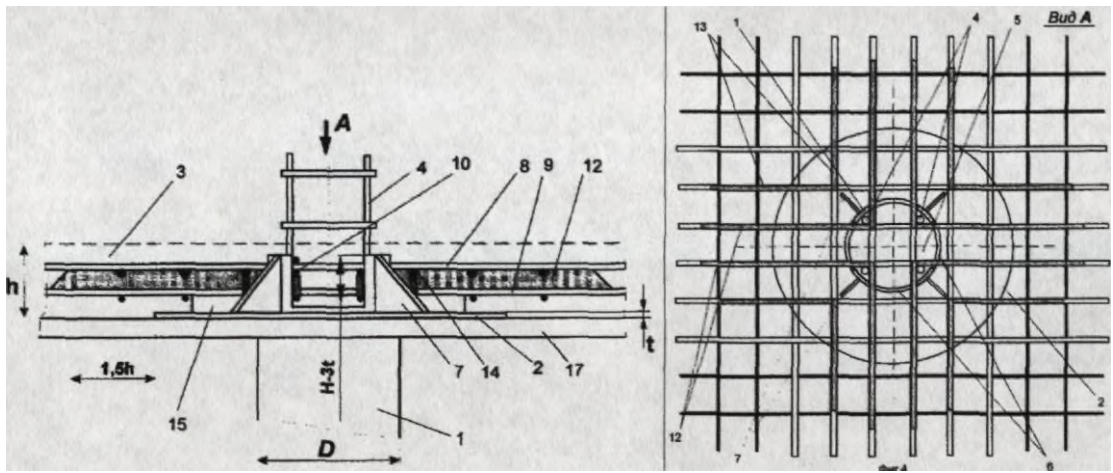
Вузол сполучення колони з плитою перекриття із застосуванням пластин: 1 - колона; 2 - опорне кільце; 3 - плита перекриття; 4 - арматурний каркас колони; 5 - бетон; 6 - виріз; 7 - косинка; 8 - верхня сітка; 9 - нижня сітка; 10 - арматурний каркас плити перекриття; 12 - внутрішня пластина; 13 - зовнішня пластина; 14 - отвори; 15 - додаткова пластина
